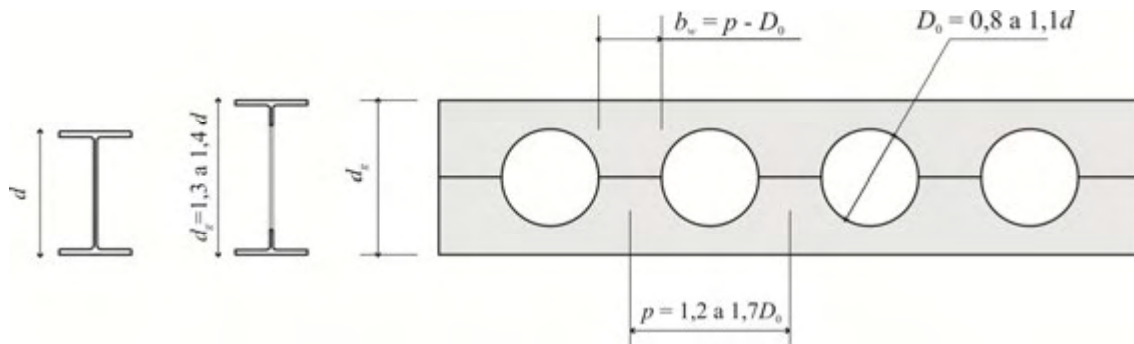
Parâmetros geométricos da viga celular com vistas à aplicação em sistemas de piso.
